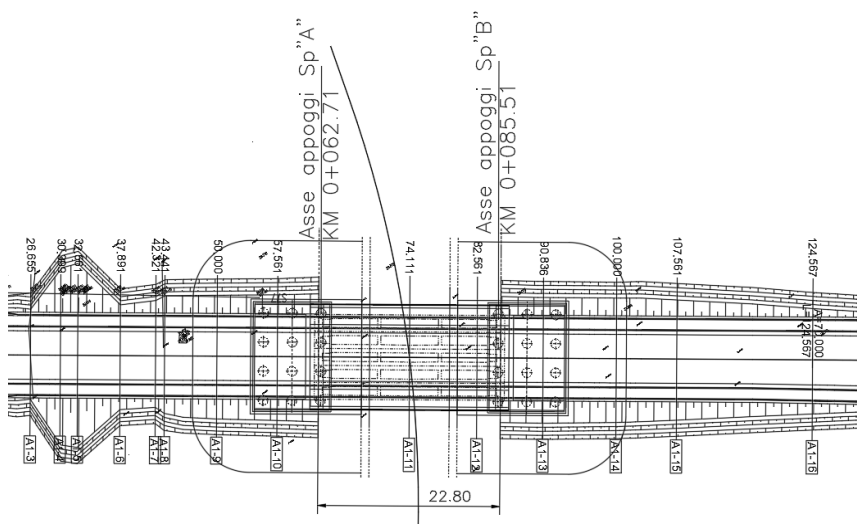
Stralcio planimetrico – ubicazione opera d'arte
